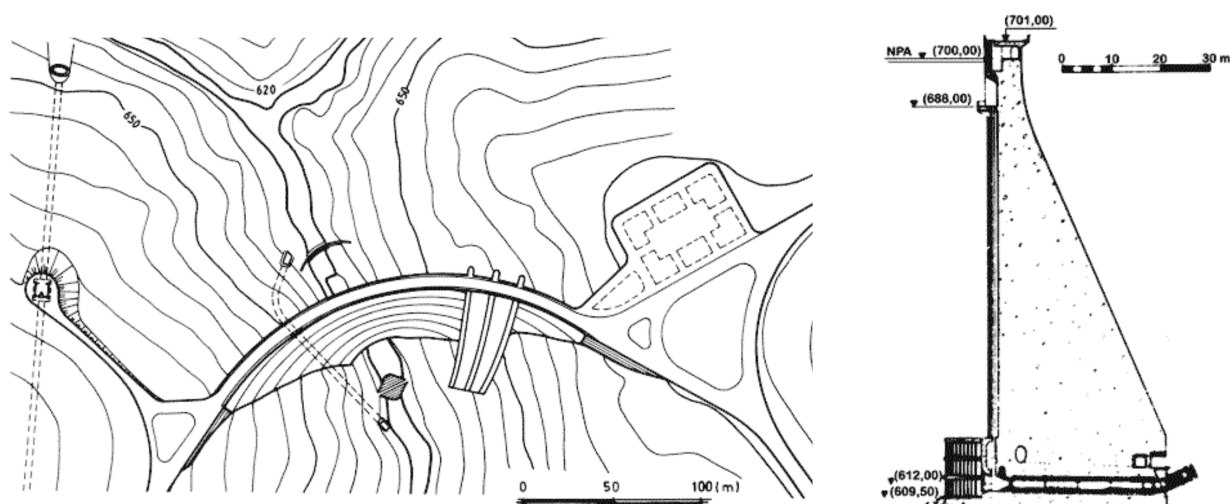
Planta e corte da barragem de Venda Nova. (cnpqg.apambiente.pt).
